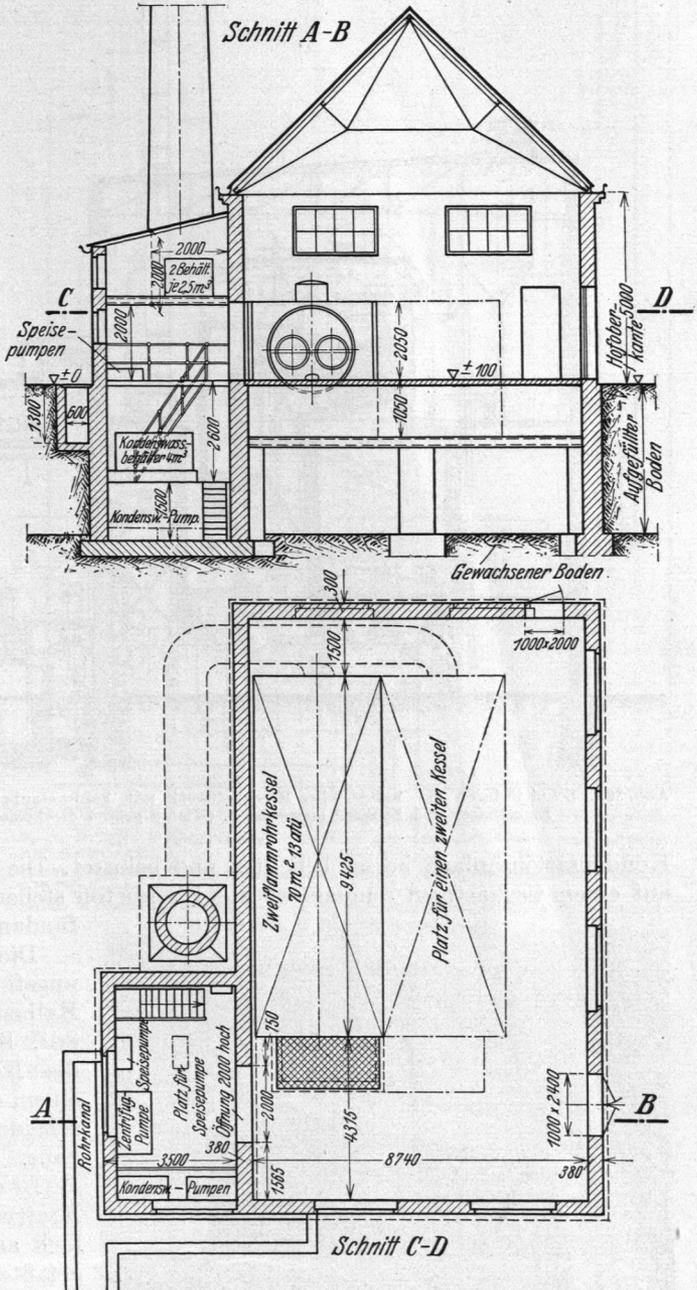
und 391. Kesselhaus für 2 Zweiflammrohrkessel mit Anbau für Speisepumpen. (Kesselzeichnung hierzu siehe Abb. 379.)
